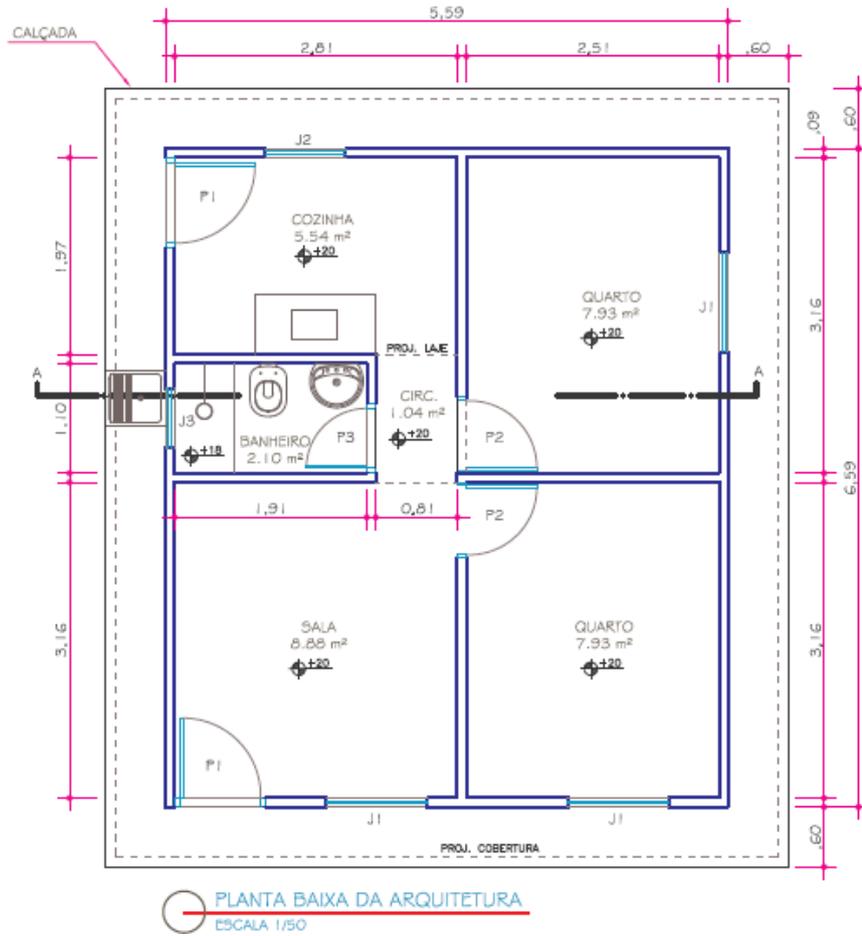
Planta do pavimento térreo original. Fonte: Silva, 2017.
